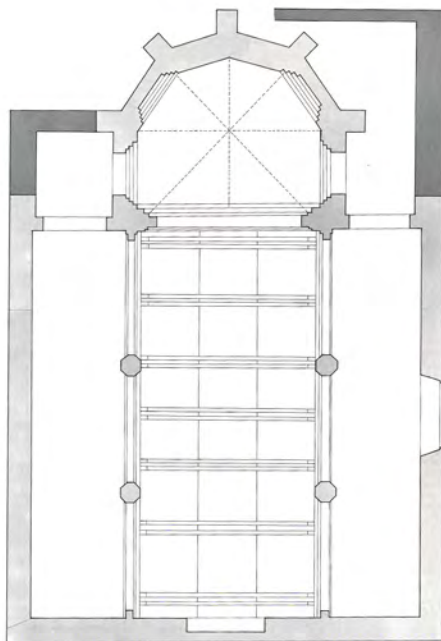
Planta de la Iglesia de Santa Clara. Pavón Maldonado
